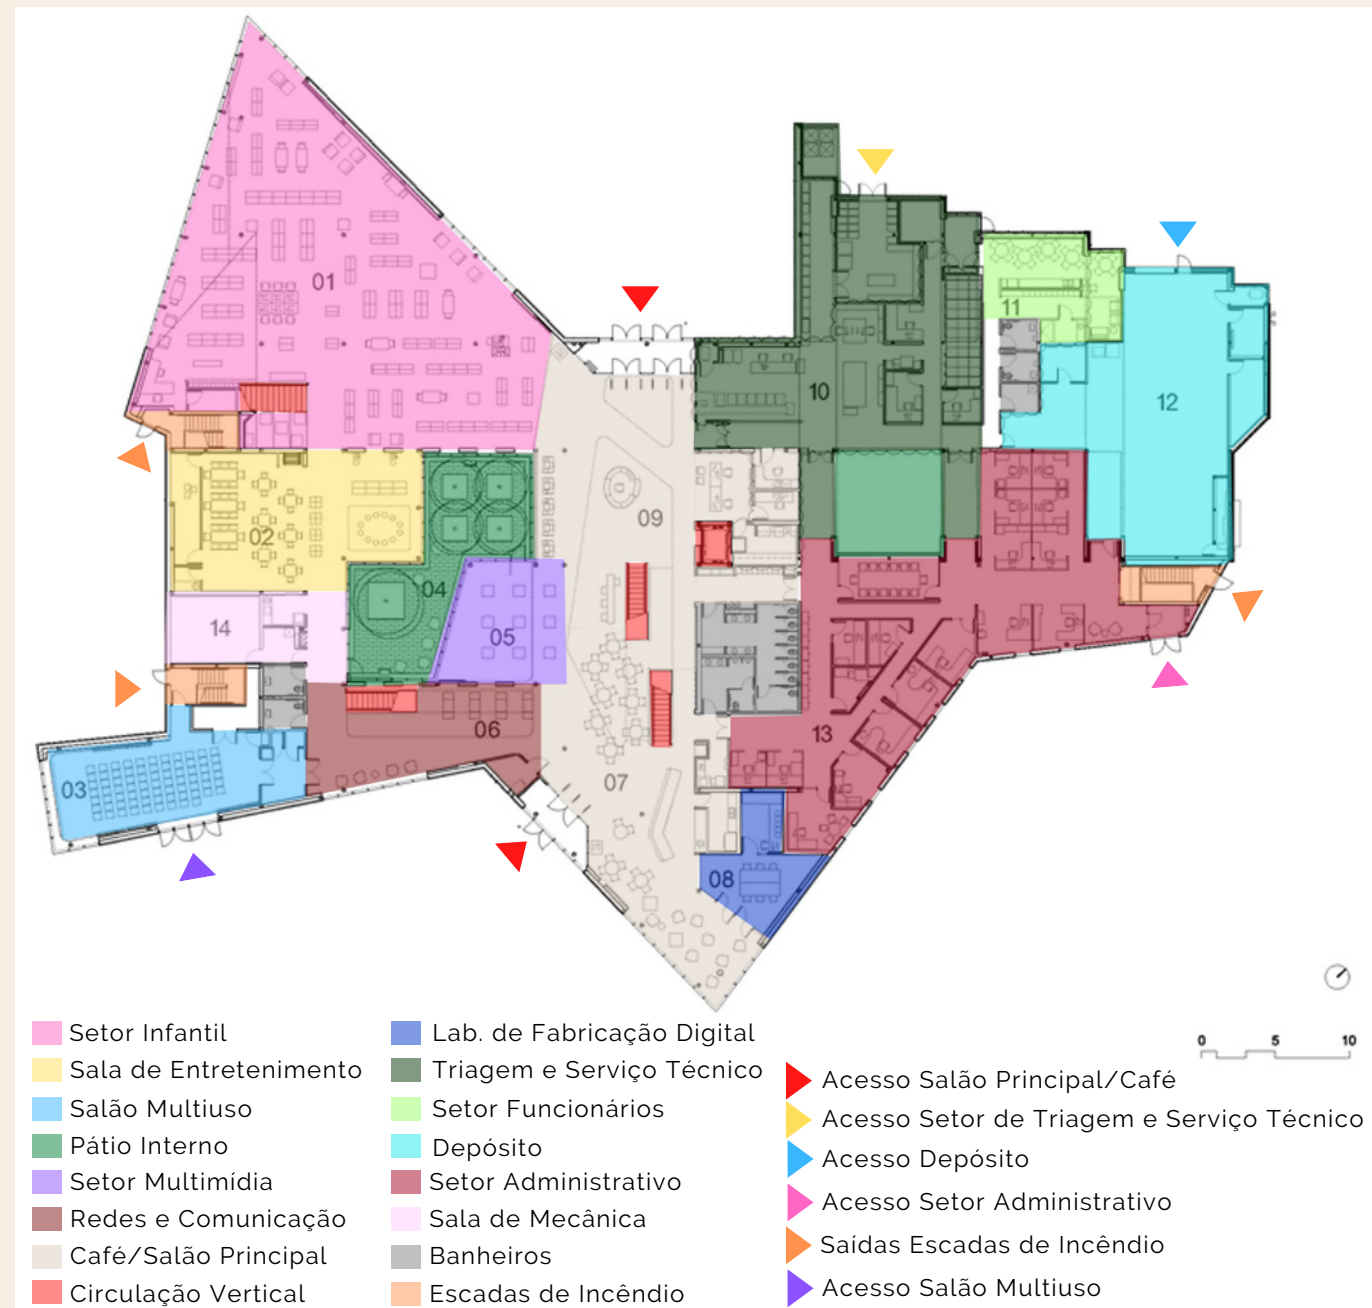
Setorização e Acessos do Pavimento Térreo Biblioteca Pública Pierrefonds
